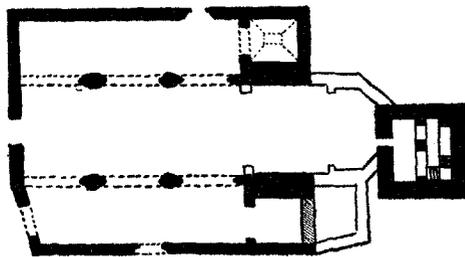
San Román —planta basilical—, torre exenta unificada en la planta con el ábside de Covarrubias. (Dib. Labrador).
